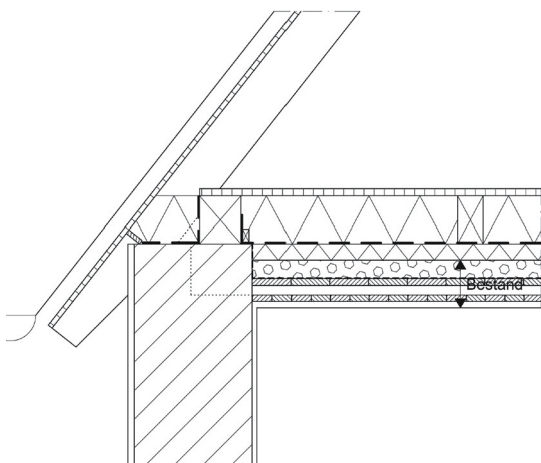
Dämmen einer Holzbalkendecke (Quelle: C. Uske)
